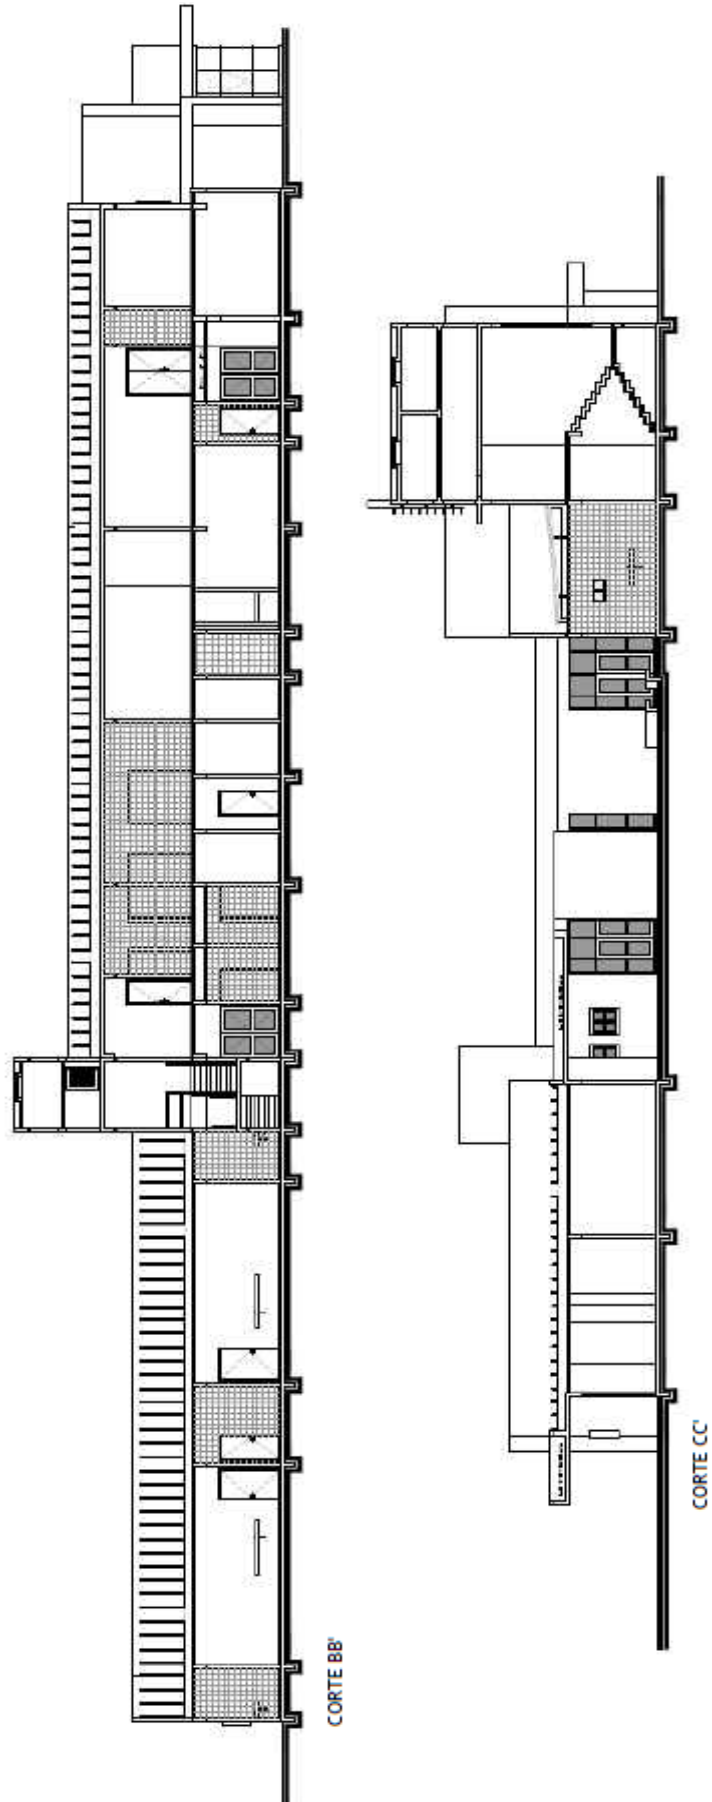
Corte longitudinal e transversal do edifício
